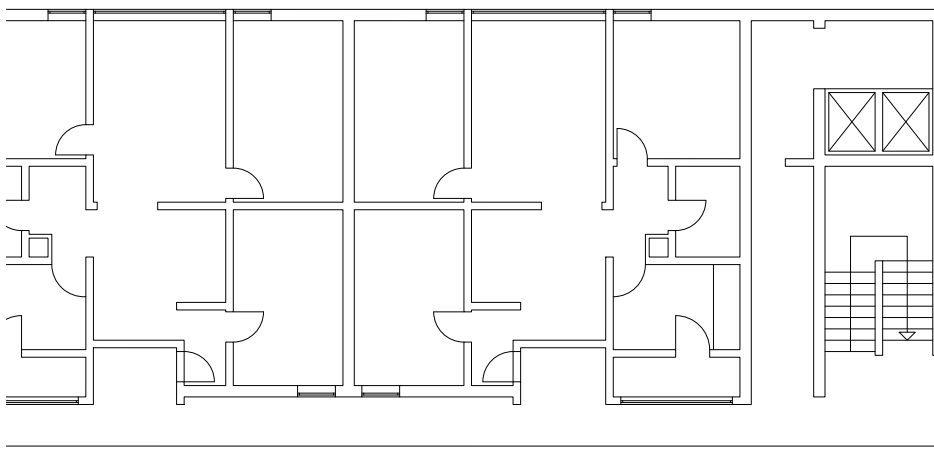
Planta Tipologia Cinco Dedos 1:200
